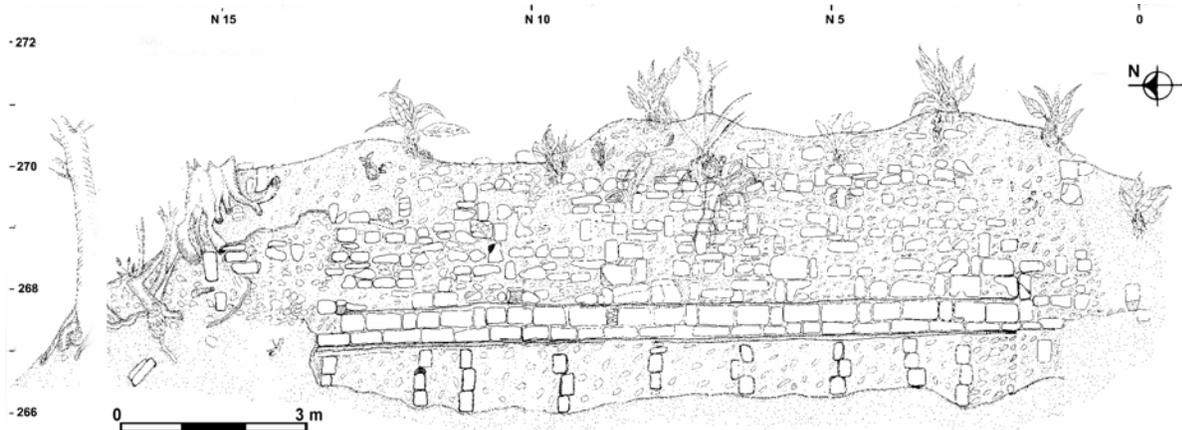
Elevación muro exterior Oeste, Estructura 5C-47, "La Herradura", Mundo Perdido
